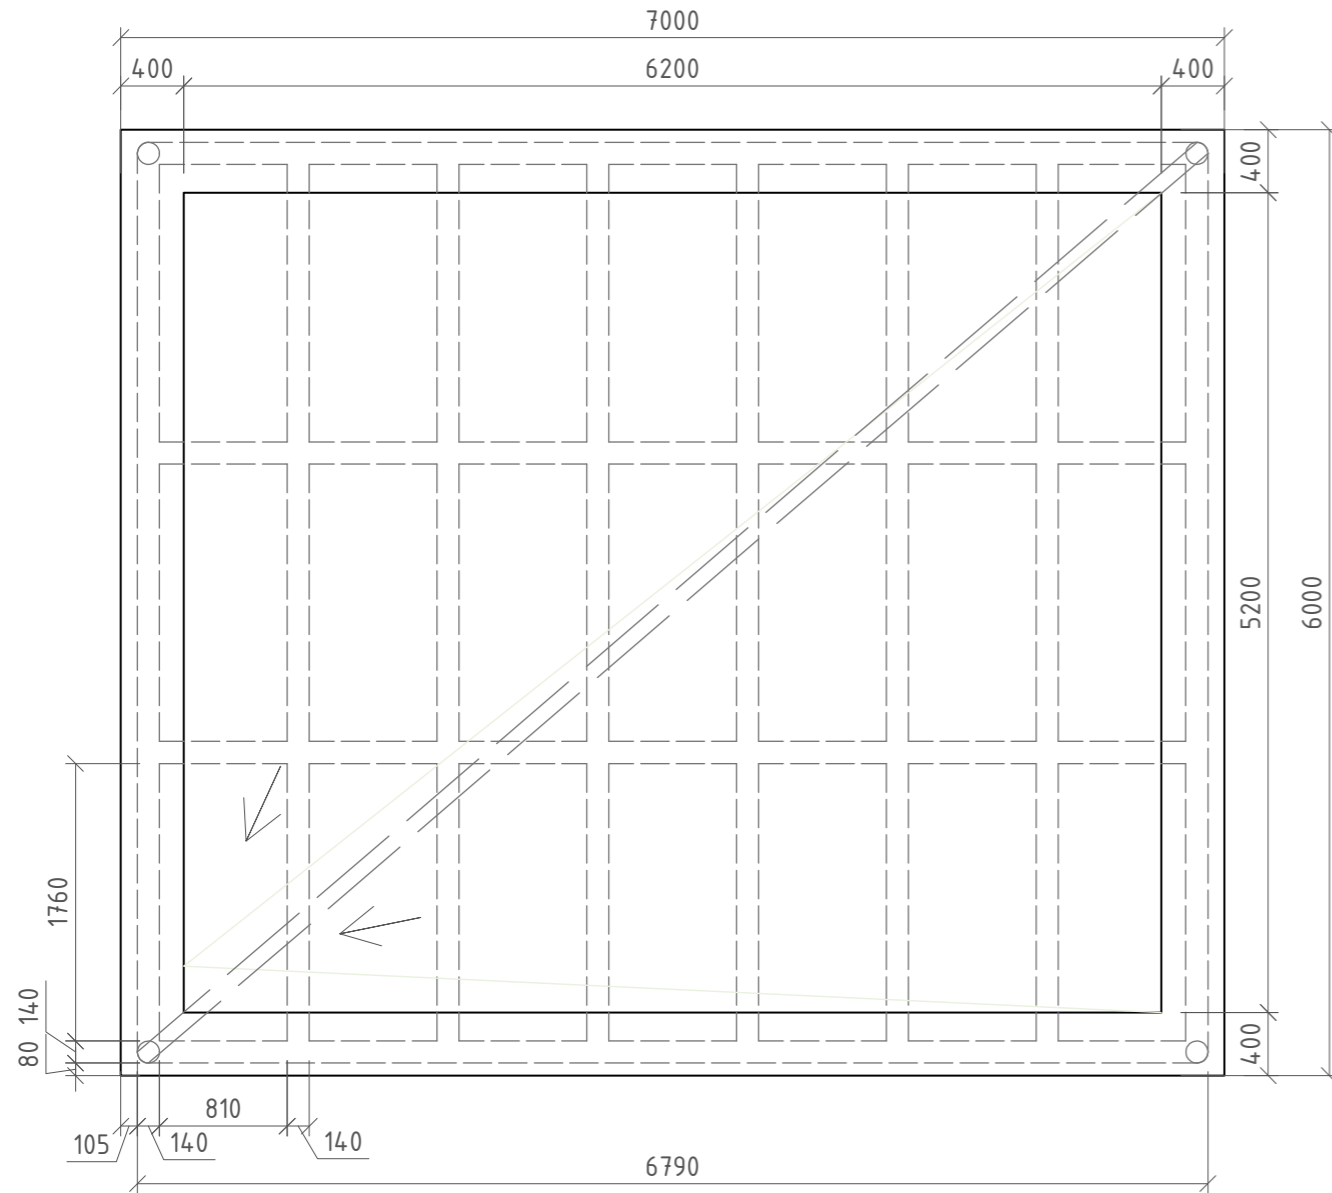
DETAIL ZASTŘEŠENÍ PERGOLY M 1:10
